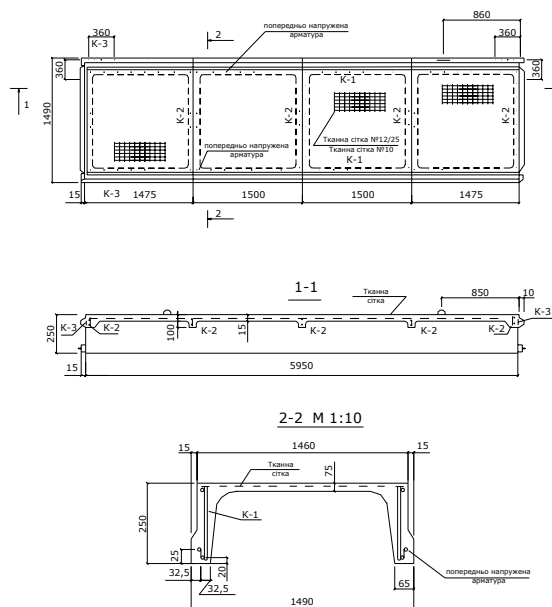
Конструкция армоцементной панели покрытия для сельского промышленного здания
